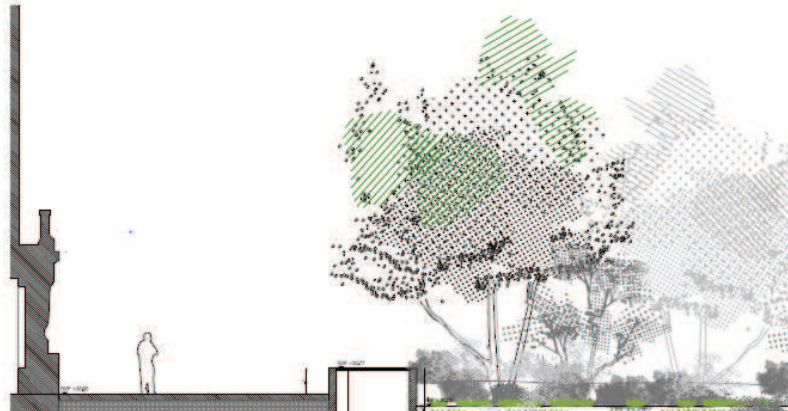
Coupe vue du Jardin de la Nouvelle France, issues de secours situées au Sud-Ouest de la Nef donnant vers une cour en amont de la rampe logistique. En cas d'évacuation, les visiteurs n'auront pas à traverser le jardin. (c) LAN et Base
